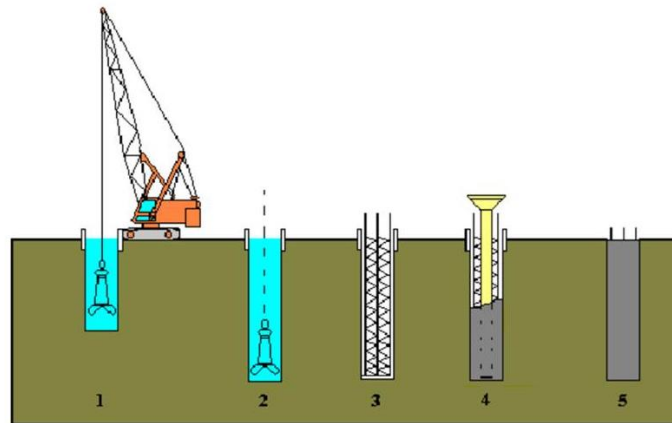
Esquema de ejecución de pilotes de Hormigón Armado
